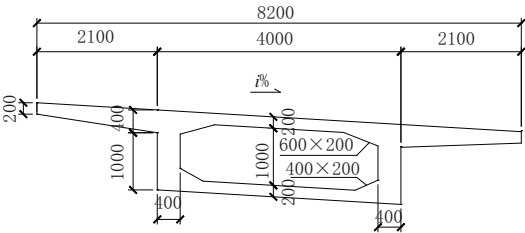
钢筋混凝土大箱梁跨中截面图(单位:mm)
